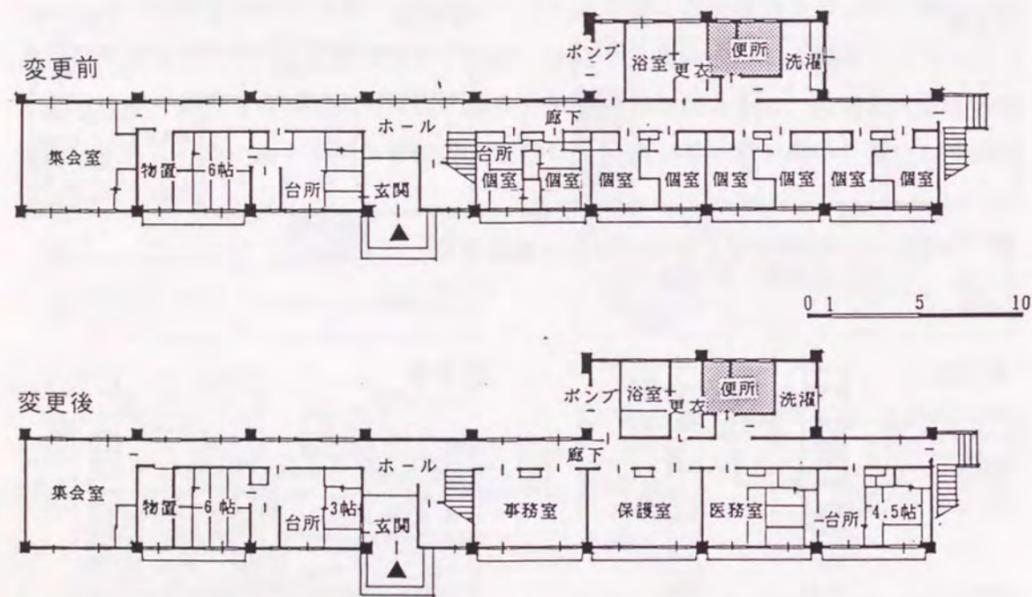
<99>千葉市母子寮（旧独身保母寮）1階平面図
